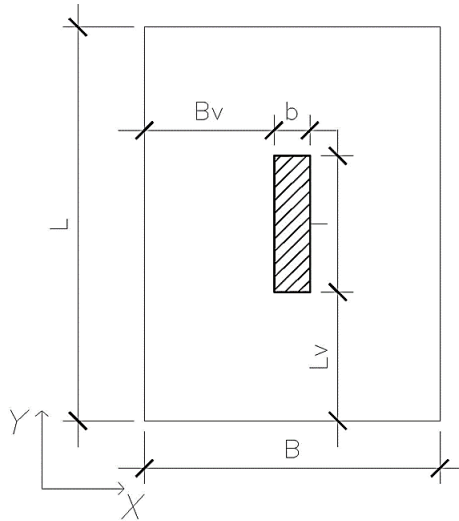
Esquema de zapata aislada con ejes coordenados.
